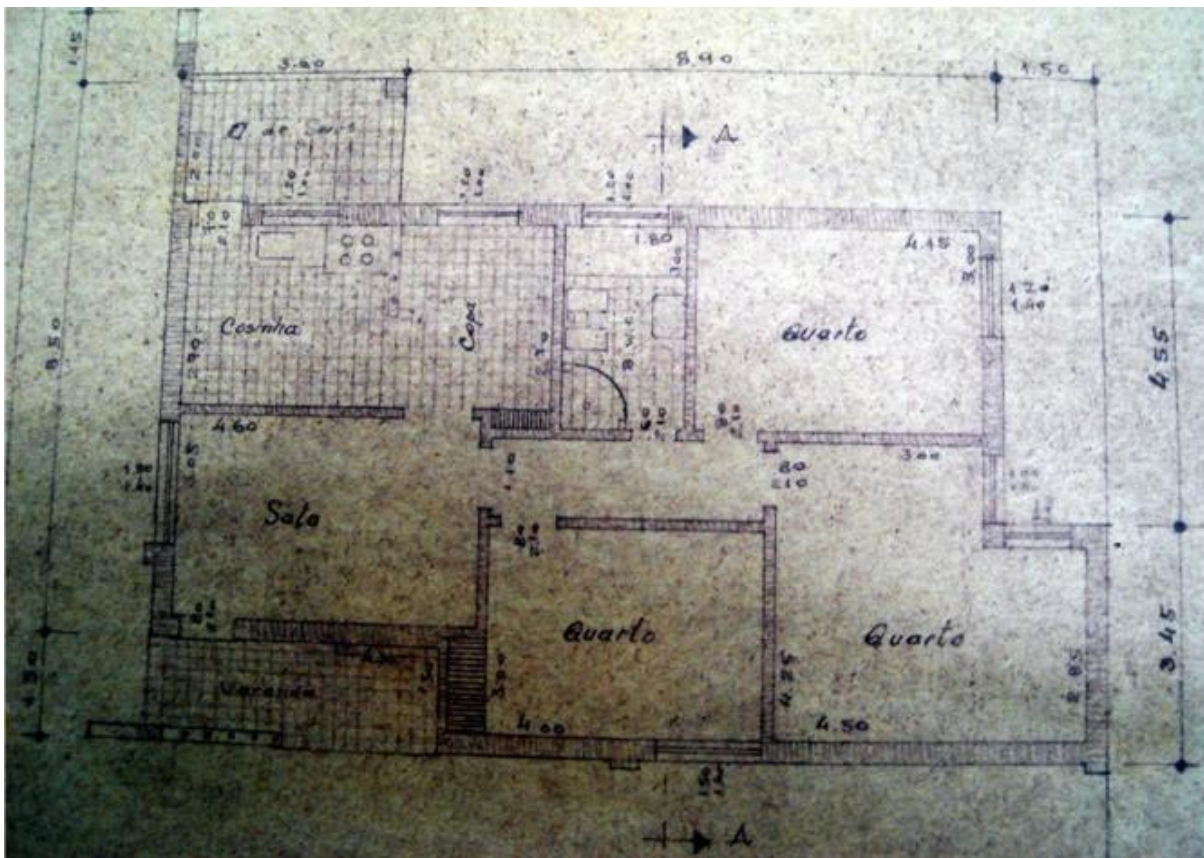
Projeto Arquitetônico / Planta baixa (Residência da Rua Tomé de Souza, nº 384)
